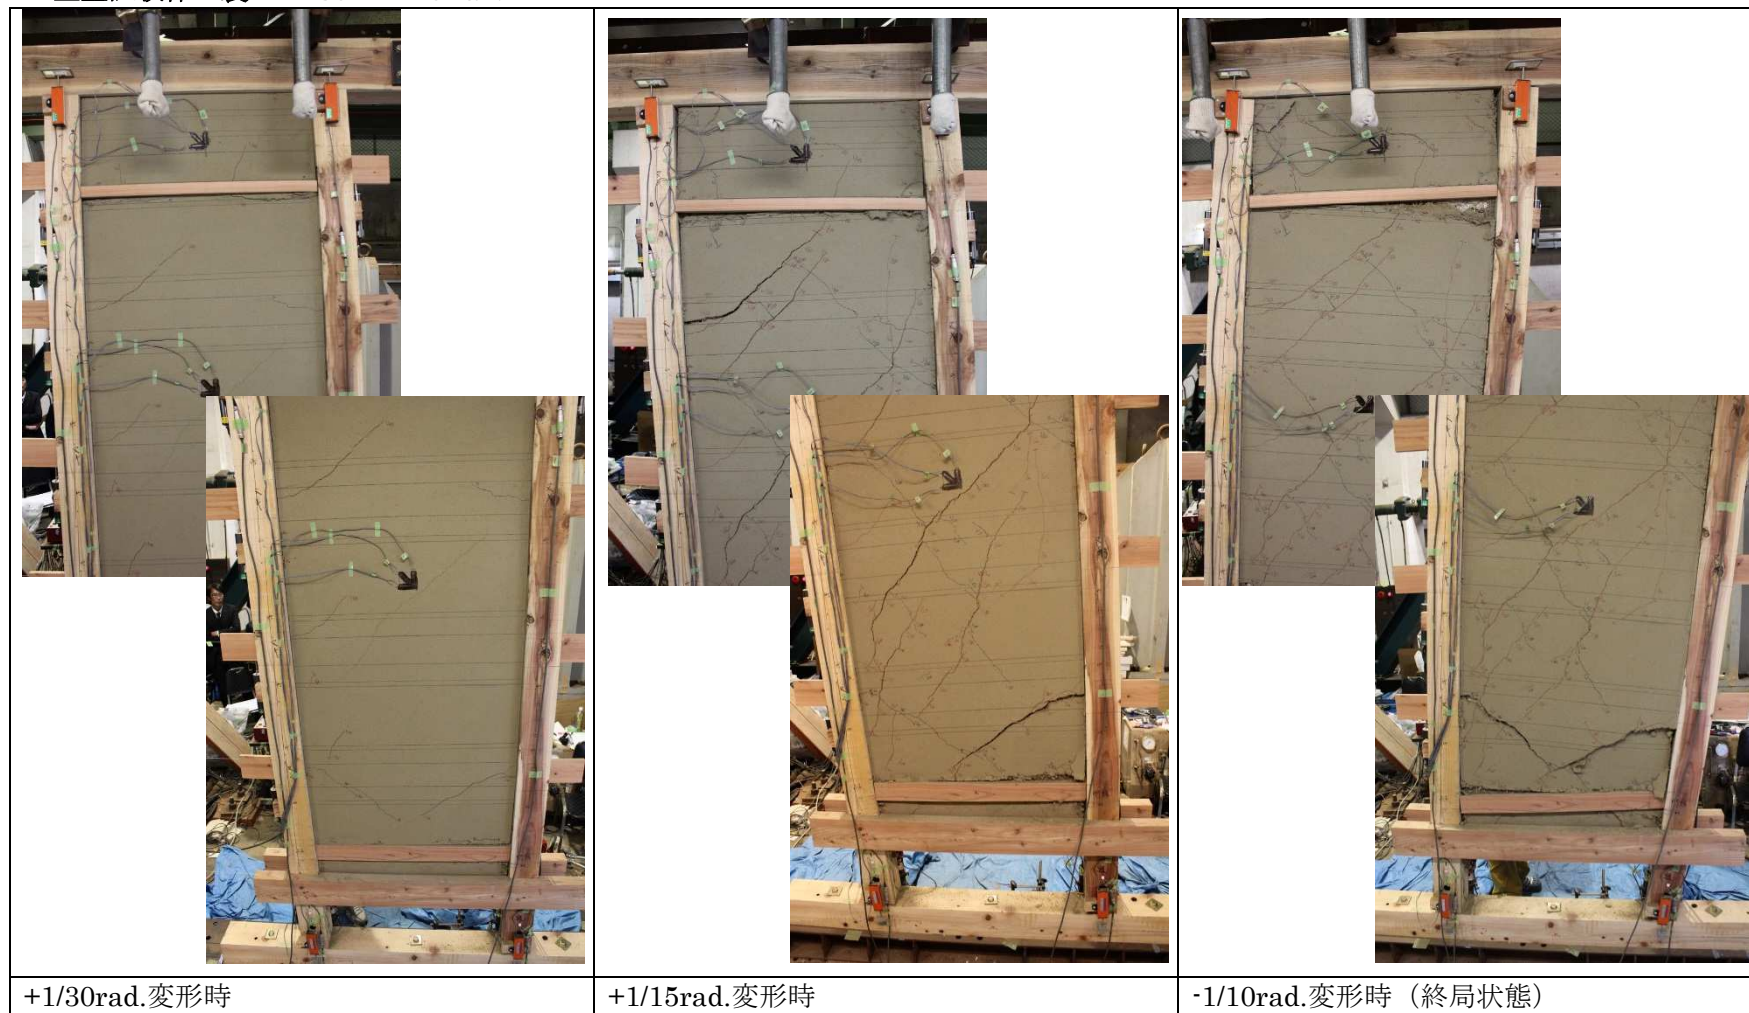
土壁試験体 裏 +1/30 - 1/10 rad.
